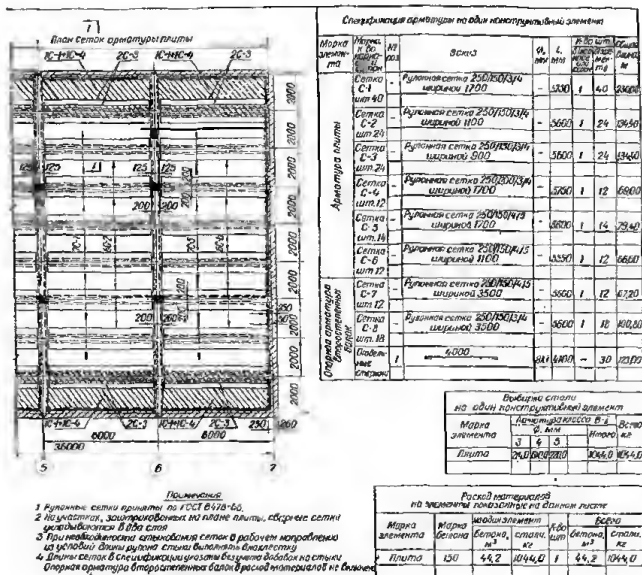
Армирование плиты ребристого перекрытия сварными рулонными сетками с поперечным расположением рабочих стержней.
